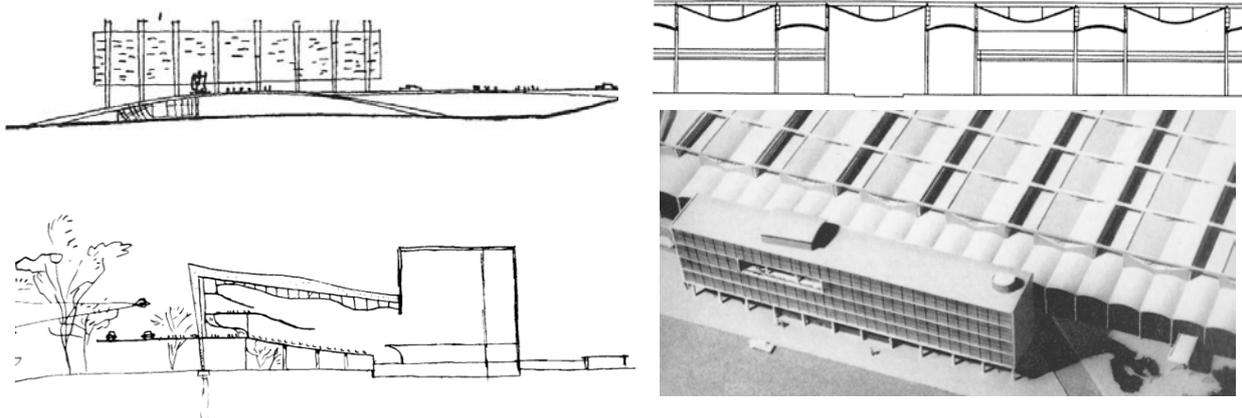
Fachada e corte do projeto para o Teatro Municipal de Belo Horizonte (1941); Figura 18: Corte longitudinal e maquete da Sede do Departamento Geral de Transporte e Oficinas da Prefeitura (1939)
